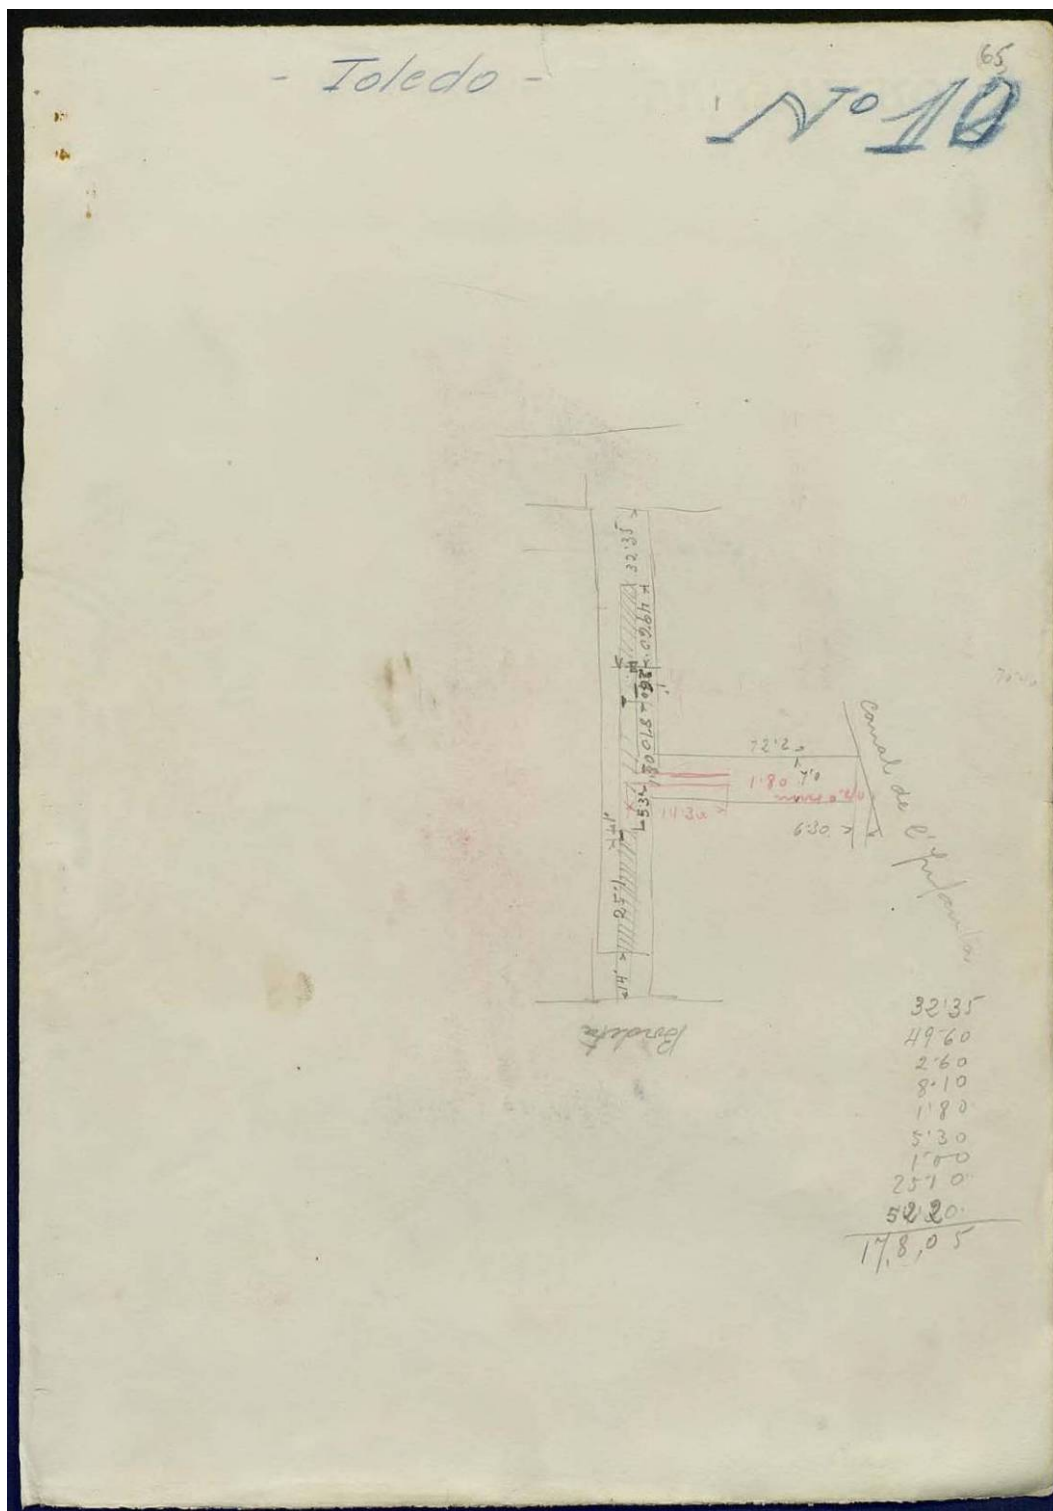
Estat final de l'obra constructiva al passatge de Toledo.
